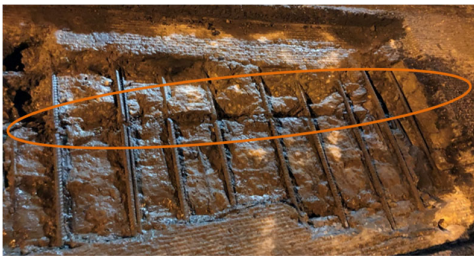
Presencia de grieta en profundidad del hormigón. Armaduras seccionadas por corrosión.
